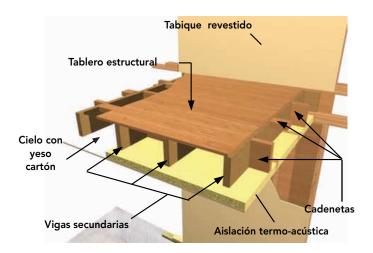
Elementos de la plataforma de entrepiso y disposición del tablero estructural.
